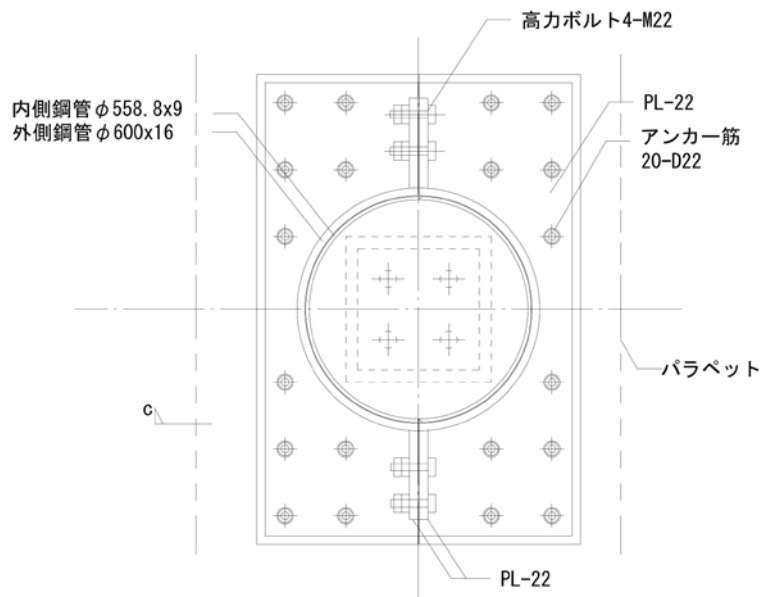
補強鋼管とあと施工アンカー詳細 (伏図)
